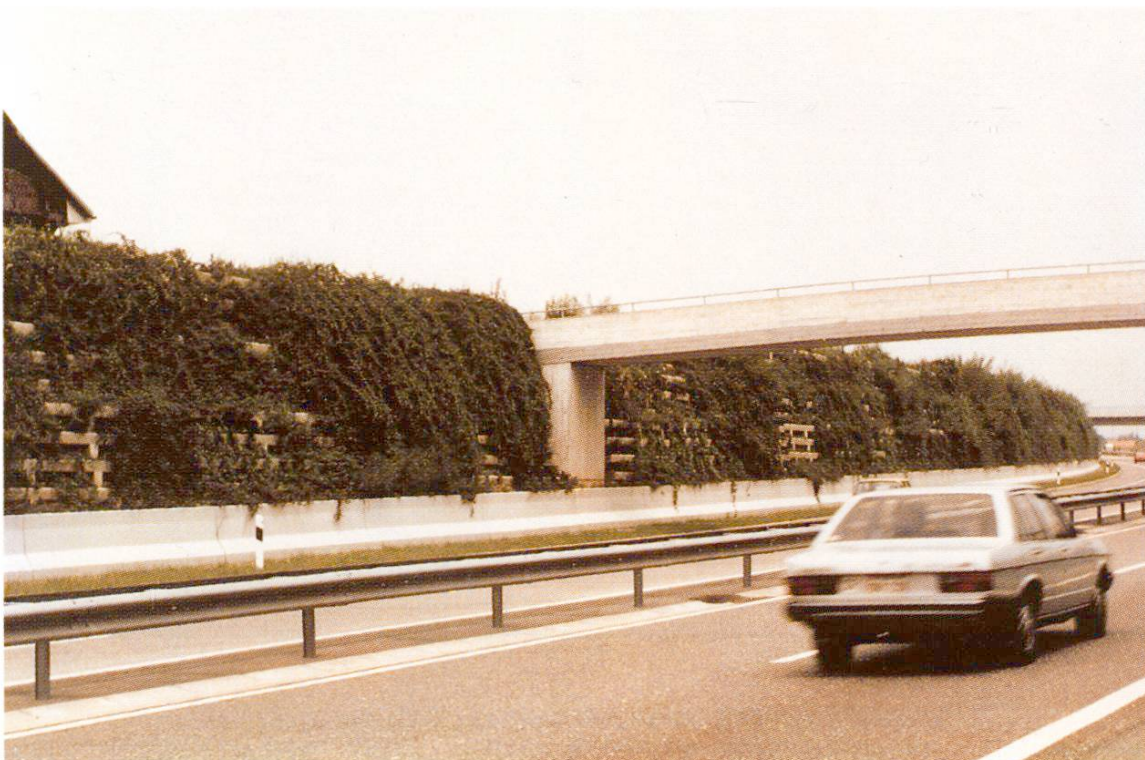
Lärmschutzwand mit Stützfunktion (N12, Ausfahrt Châtel-St-Denis). Mit dem System Evergreen sind Wandhöhen bis zu 12 m möglich.
